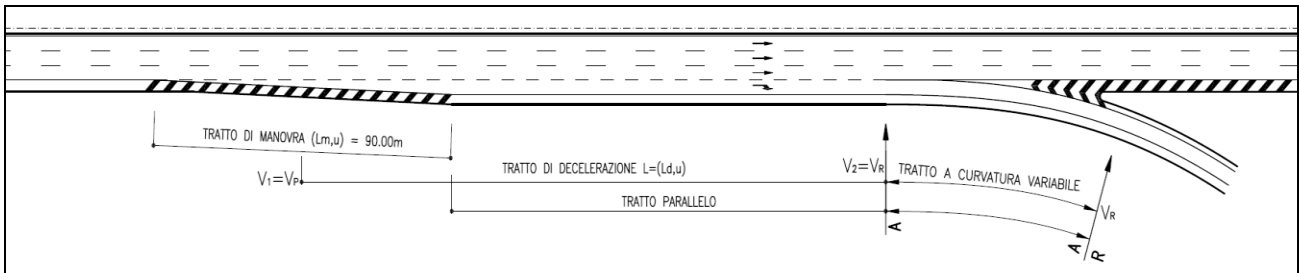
SCHEMA PLANIMETRICO DELLA CORSIA DI DIVERSIONE
